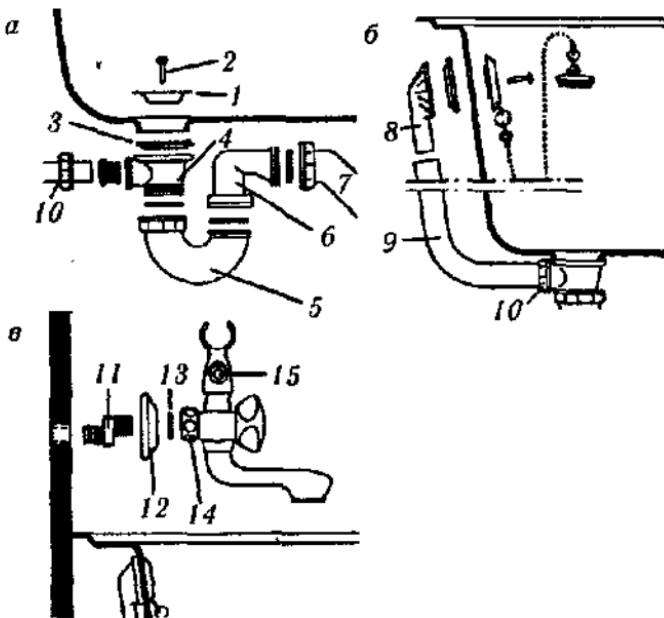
Монтаж оборудования ванной: а — монтаж сливной аппаратуры; б — монтаж перелива; в — монтаж смесителя для ванны; 1 — сетка; 2 — винт; 3 — прокладка; 4 — тройник; 5 — сифон; 6 — угольник; 7 — отвод; 8 — выпуск перелива; 9 — труба; 10 — гайка; 11 — Z-образный патрубок; 12 — розетка; 13 — прокладка; 14 — накидная гайка; 15 — шланг ручного душа.
